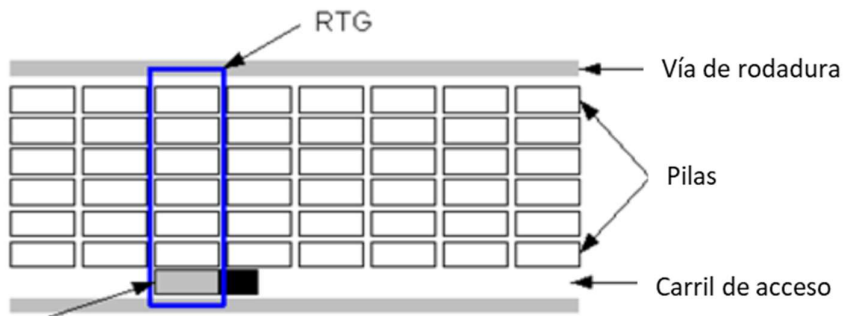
Pistas RTG típicas (fuente: Pianc REPORT N° 165)
